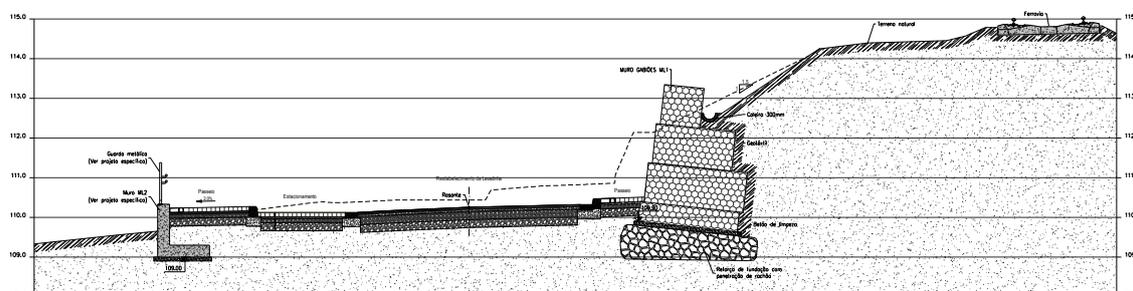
Perfil transversal 3-3' - ML1 (Secção 3)
